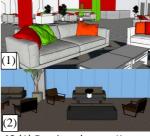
(1) Plafon Gypsum dengan Ukiran Sarang Madu dan (2) Plafon Gypsum Tanpa Aksen/Ukiran pada Lobby Hotel
